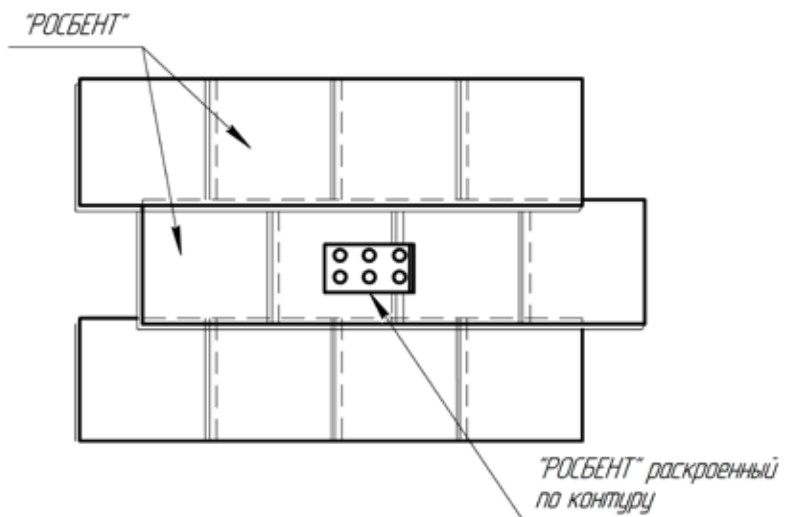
Раскрой и укладка «Росбента» в местах конструкций, проходящих через стену
